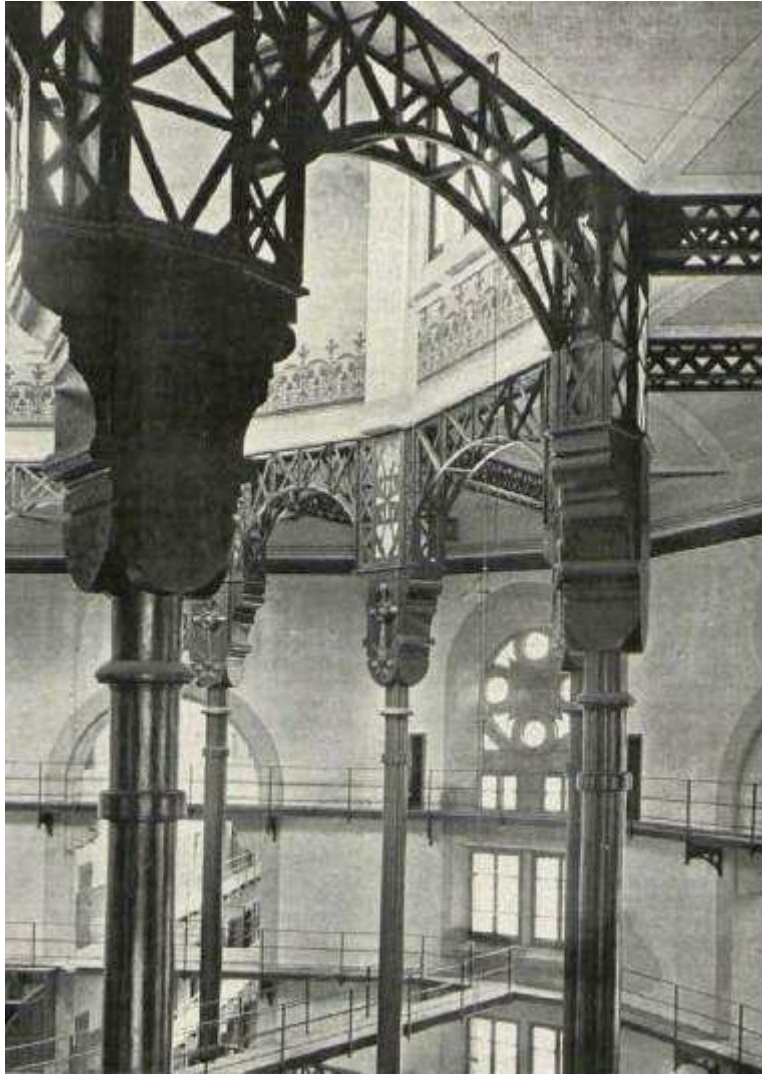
Fig. IV.XX. (p.ant) Vista general de la estructura metálica que sostiene las galerías perimetrales y la cúpula del cuerpo central del panóptico de la Prisión Modelo de Barcelona / Fig. IV.XXI. (izq.) Detalle de las columnas y capiteles de hierro fundido [“Nueva Cárcel Celular; Barcelona”, *Arquitectura y Construcción*, Año VIII, 142, mayo de 1904, p.151].
